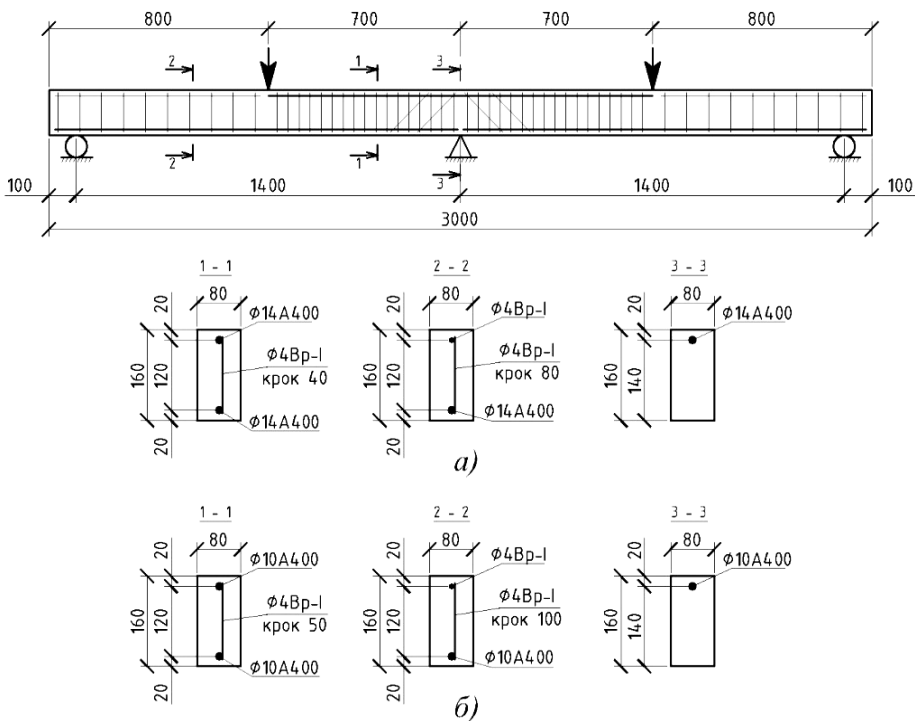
Конструктивна схема дослідних балок. а) армування ЗБ балок; б) армування СФЗБ балок
